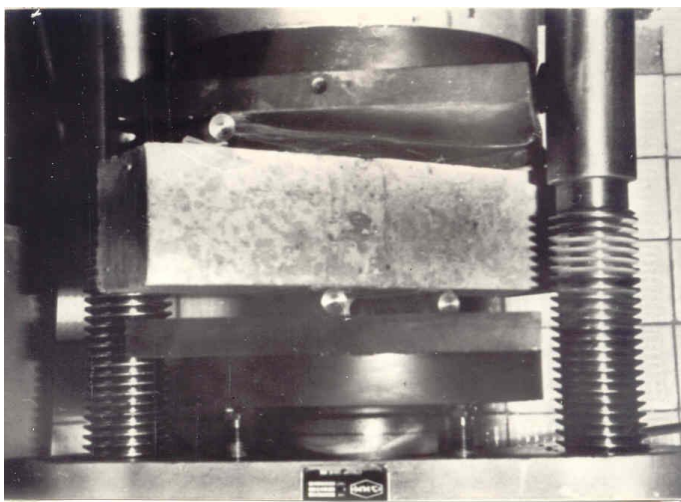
Випробування на вигин з'єднань старого бетону з новим
